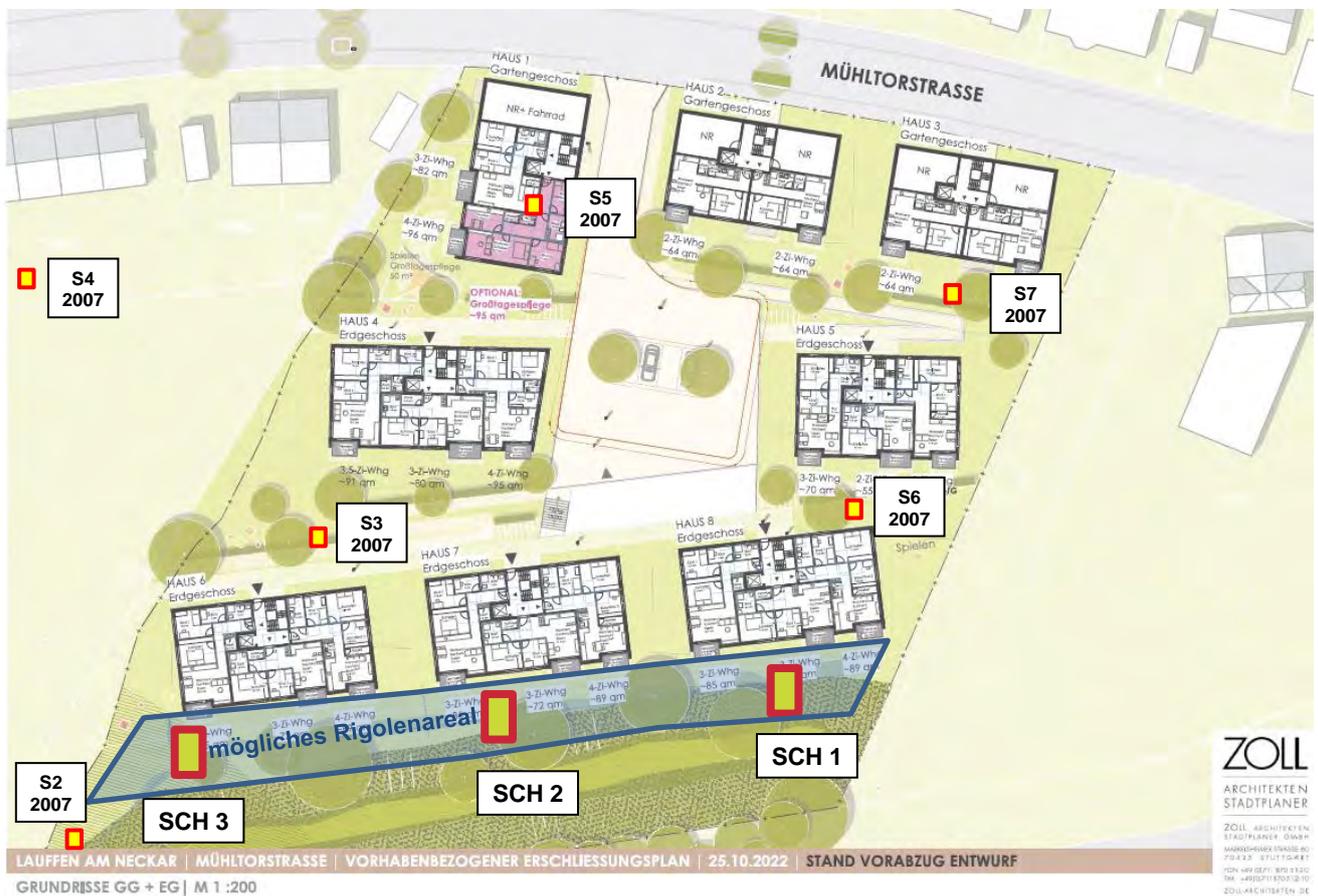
Grundriss Gartengeschoß mit Lage der Aufschlüsse
